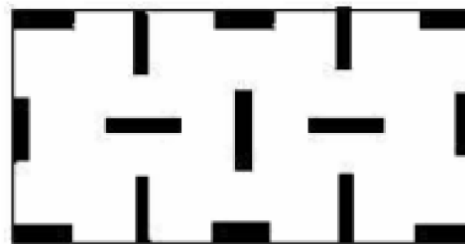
Çerçeve sistem plan ve kesit şeması (Taş, 2013).
